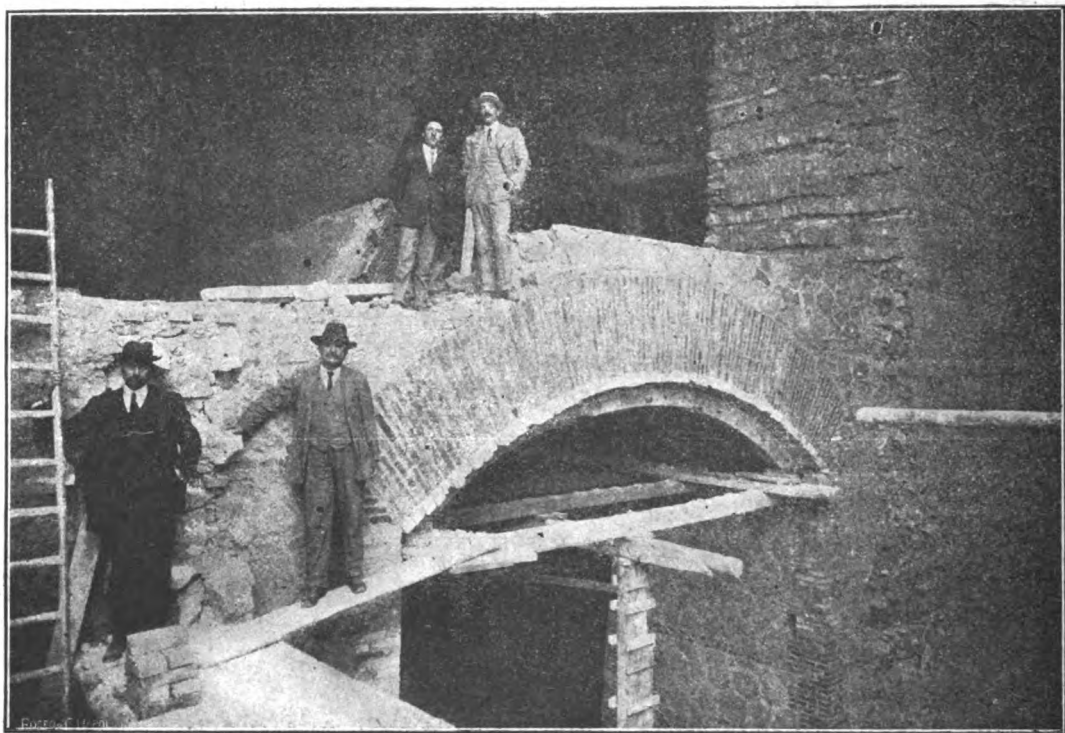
Piedritto destro della galleria, in corrispondenza dell'attraversamento d'una delle cave preesistenti, all'imbocco Napoli.
